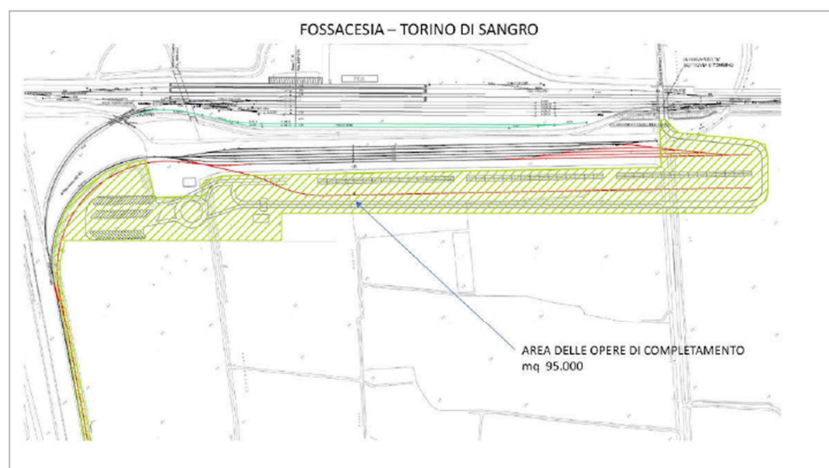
Stralcio planimetrico intervento Scalo Fossacesia
